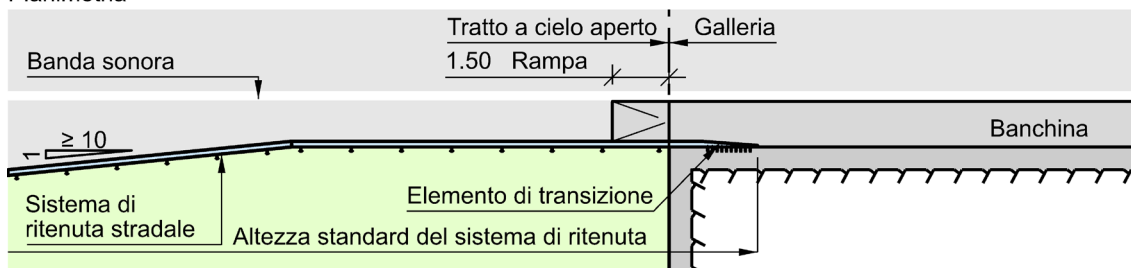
Variante 2b – Barriera di sicurezza fissata alla parete della galleria
